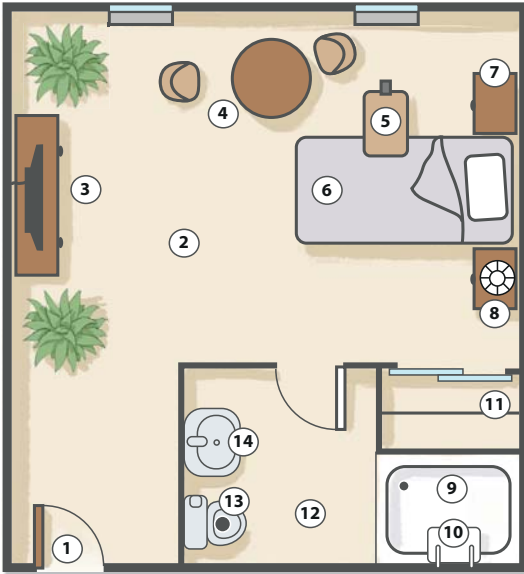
Grundriss eines Bewohnerzimmers
